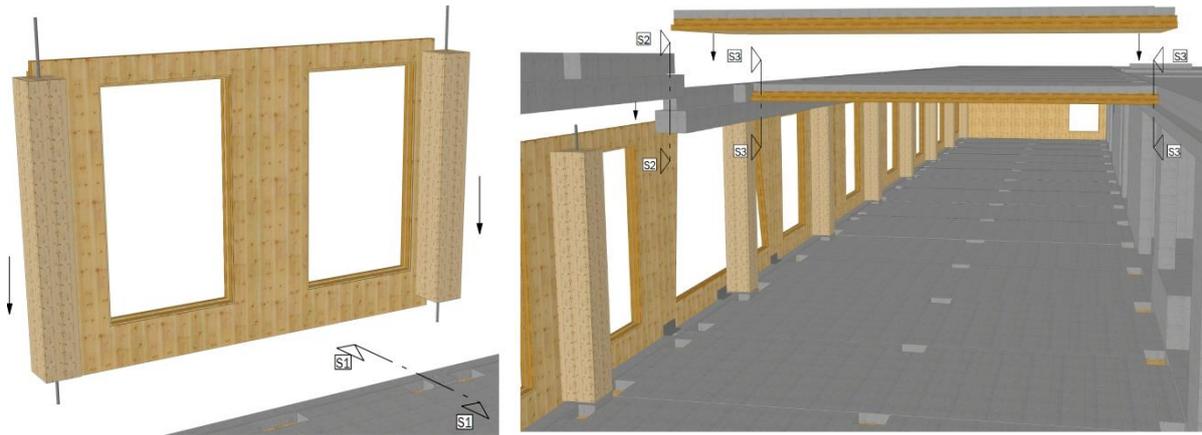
Montage (1) Holzwand inkl. Stütze, (2) Träger, (3) Decke
